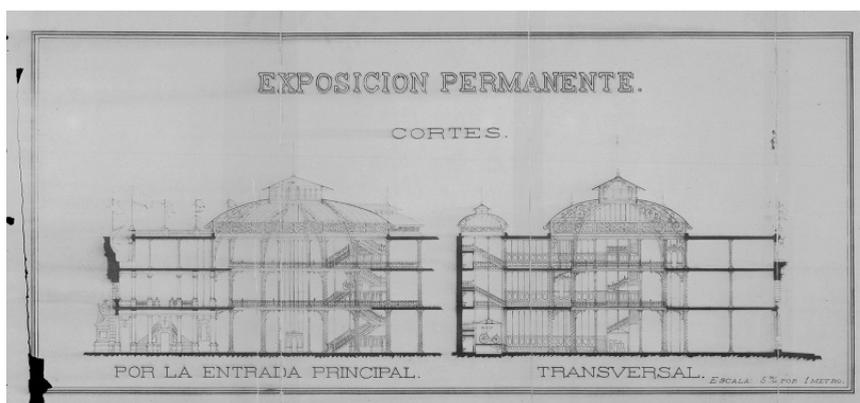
Plano de cortes del edificio de la CMEP.
